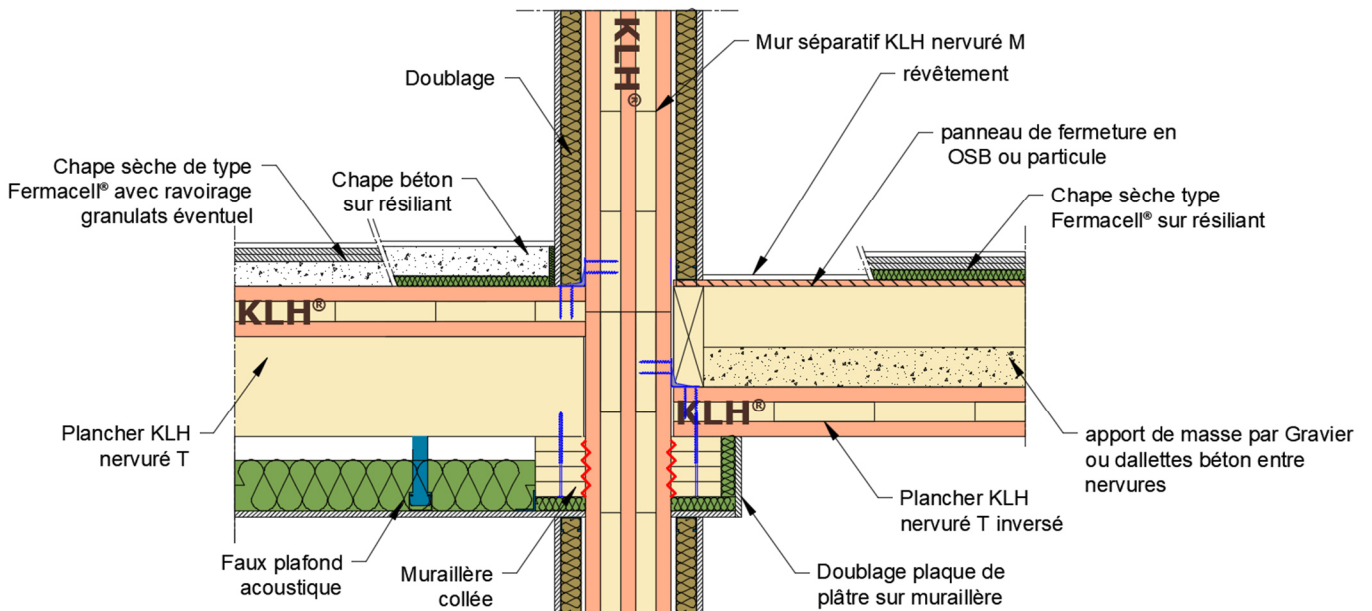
Exemple de coupe verticale sur locaux mitoyens et superposés avec interruption du plancher nervuré KLH®-CLT T et appui sur mur KLH®-CLT nervuré M - et plancher nervuré KLH®-CLT T inversé à droite avec appui sur mur KLH®-CLT nervuré M
